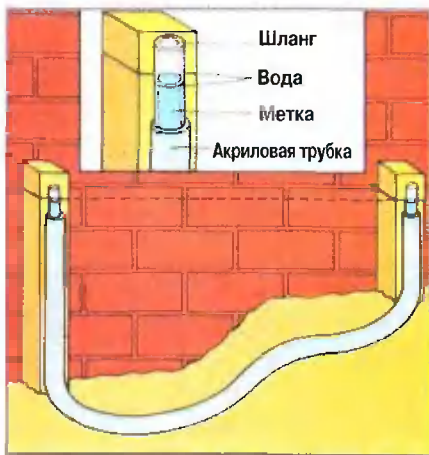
Самодельный гидроуровень, изготовленный из поливочного шланга и двух трубок из акрилового стекла
